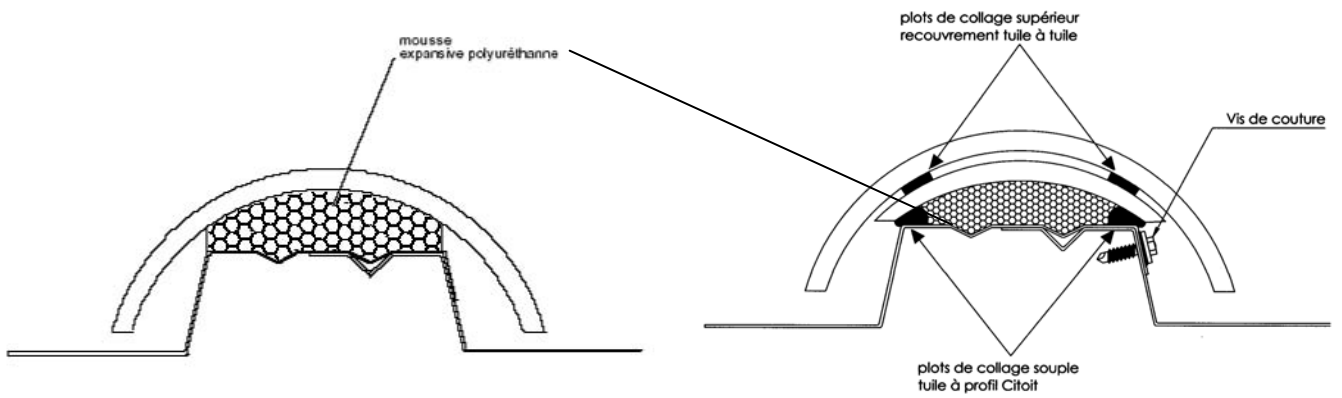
Coupe sur collage souple (pente \leq 35 %)
